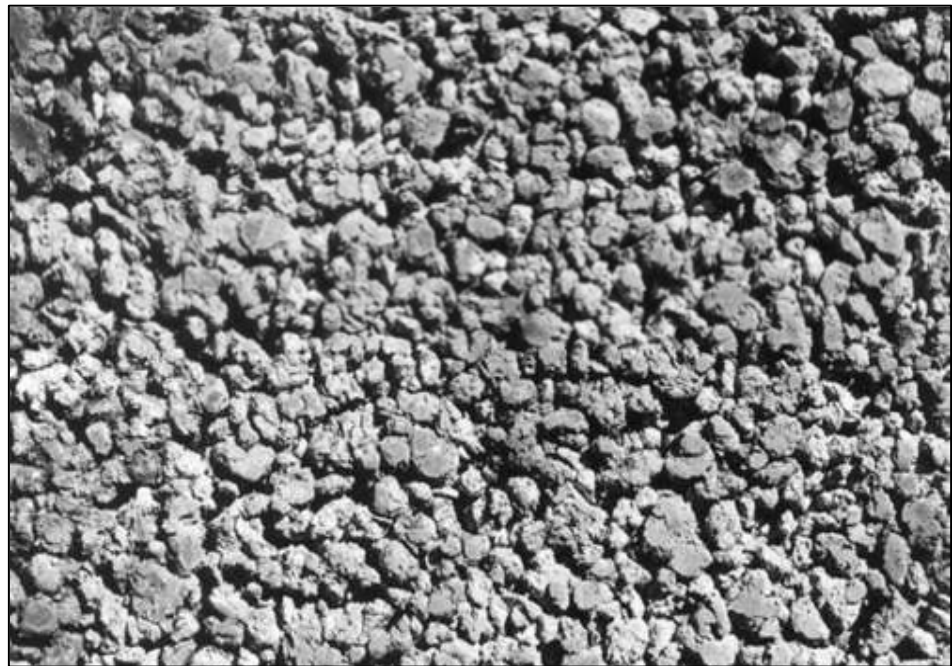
Vista de la textura de un pavimento de concreto permeable.
